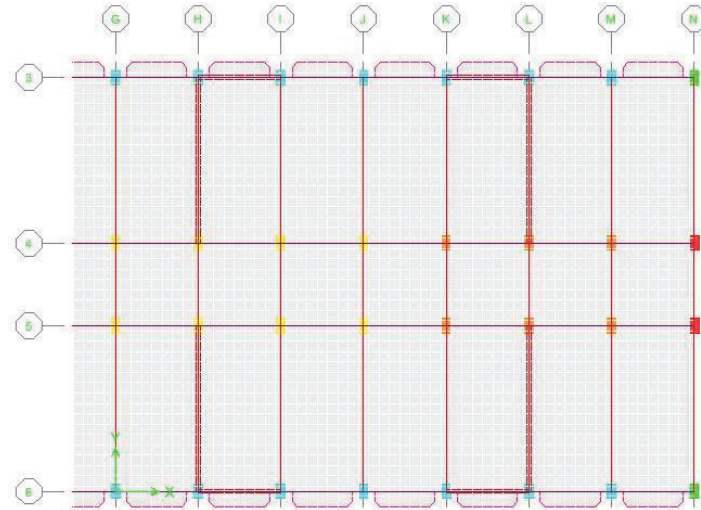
PLANTA DEL MEZANINE N+3.40 BLOQUE A
